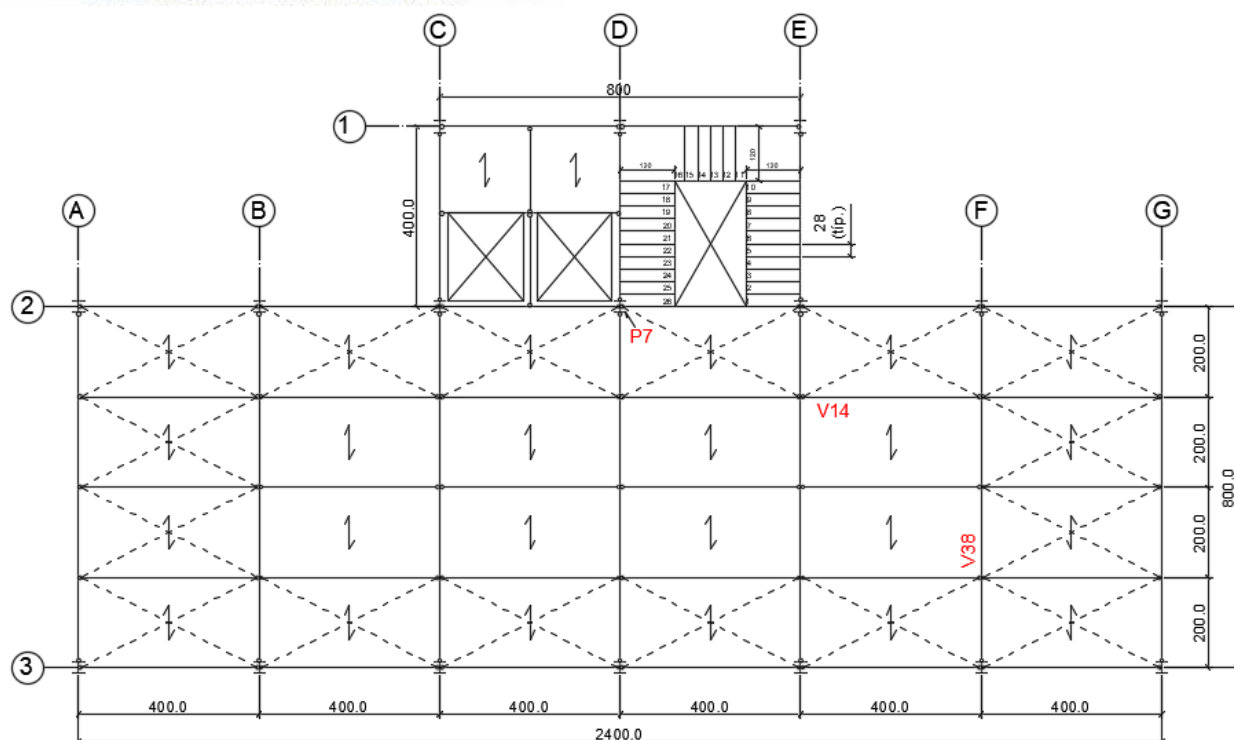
Planta unifilar do pavimento tipo destacando viga secundária (V14), principal (V38) e pilares (P7) escolhidos para a comparação.
